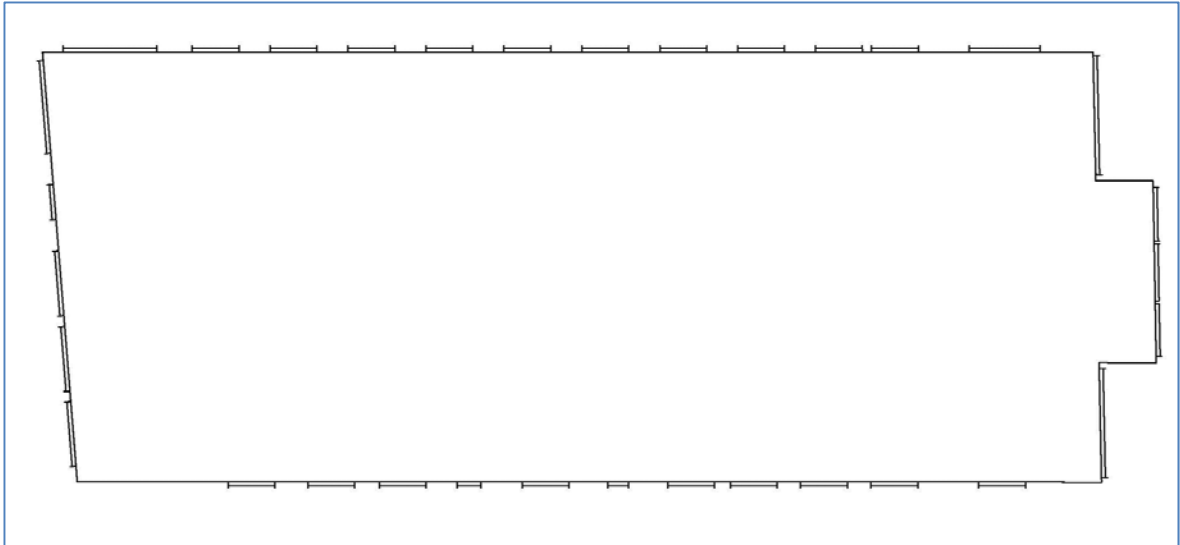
Silueta efectuada a partir del plano de planta segunda del Proyecto de Ejecución. (Efectuada por la cara interior de la fachada).
